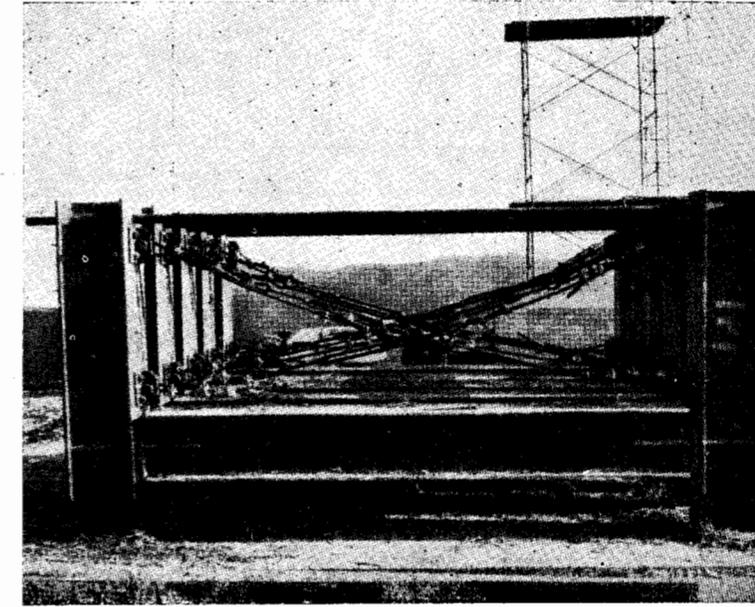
Armadura de tensión que mantienen en su sitio a las losas durante el hormigonado de la abertura. Una vez terminada dicha operación se procede a sacar la armadura. Esto constituye uno de los trabajos finales en la construcción del tramo.
